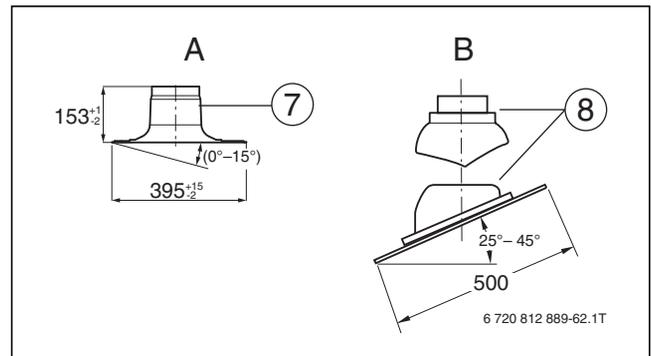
Universaldachpfannen und Flachdach-Klebeflansch als Zusatzausstattung für den Grundbausatz DO (unbedingt mitbestellen), (Maße in mm)
